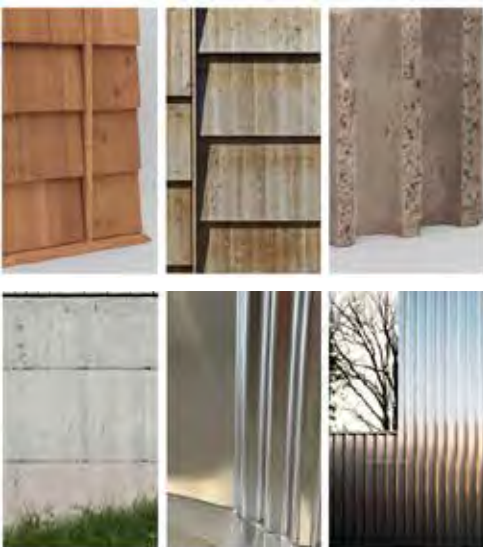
Materialesammensætning i delområde B udgøres af træ på klink, profilerede metalplader samt beton.
